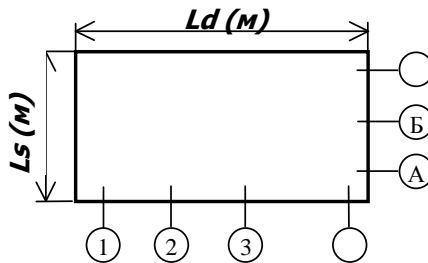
Схема этажа здания по наружному обмеру с осевой разбивкой
